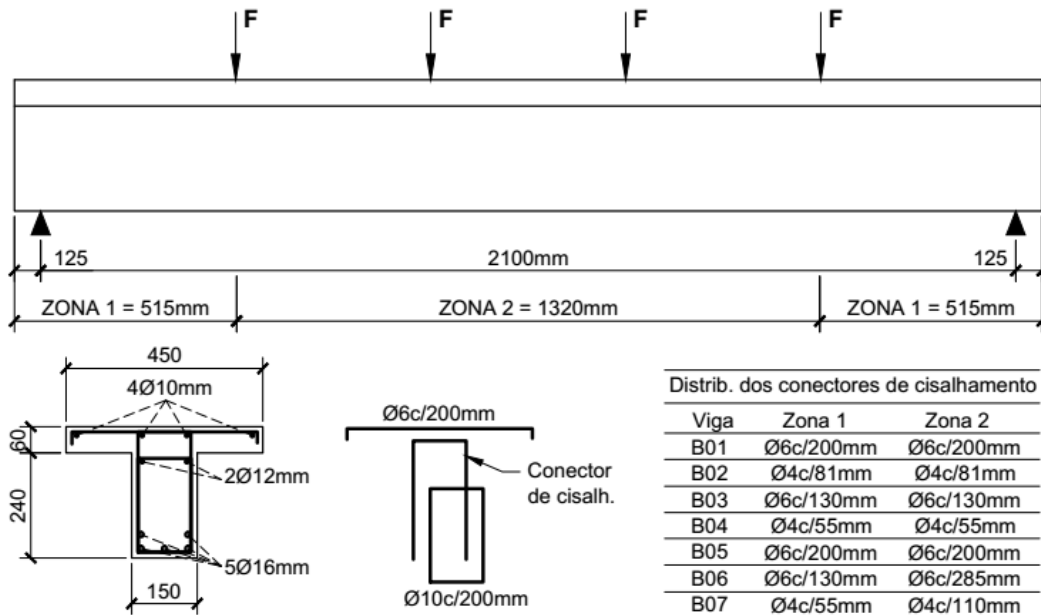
Vista lateral e detalhamento das vigas ensaiadas (MAHMOUND *et al.*, 2013).
